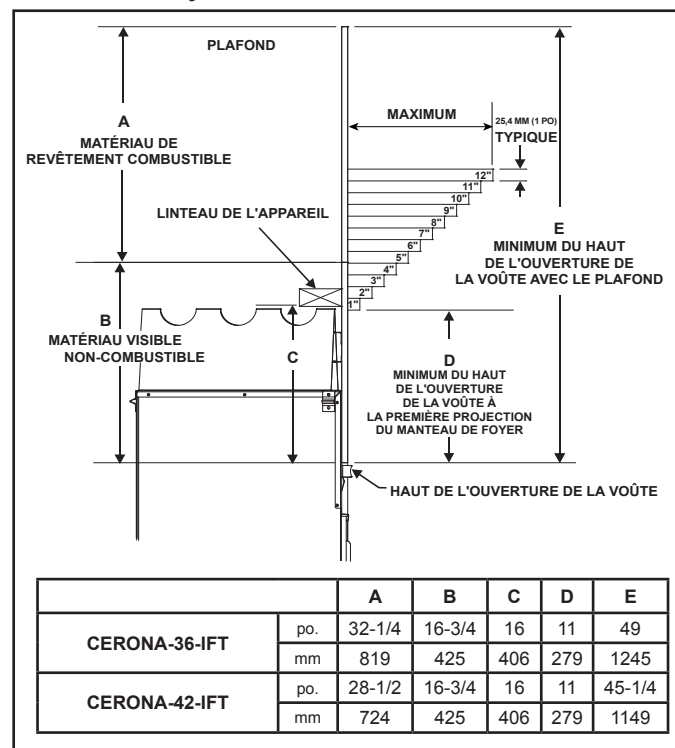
Dégagements par rapport aux manteaux de foyer ou d'autres structures inflammables au-dessus de l'appareil
